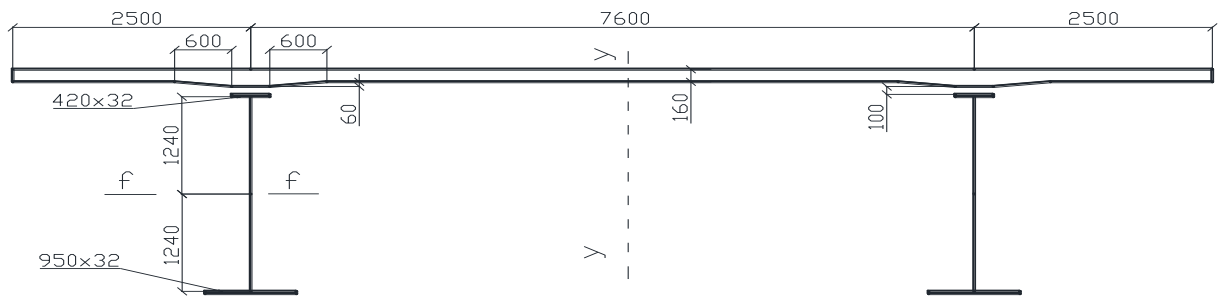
Переріз сталезалізобетонної балки в середині прогону 42,0 м
